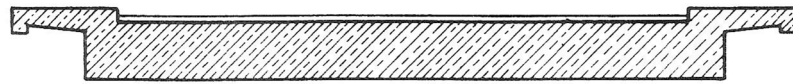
Superestrutura em laje maciça (LEONHARDT, 1979)
